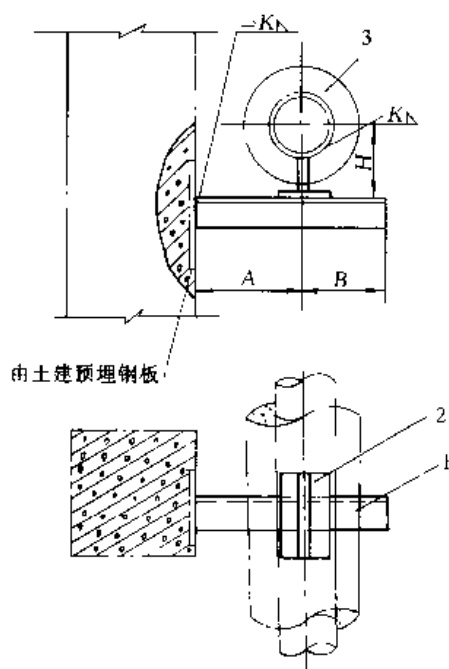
焊接在钢筋混凝土预埋件上的滑动支架
